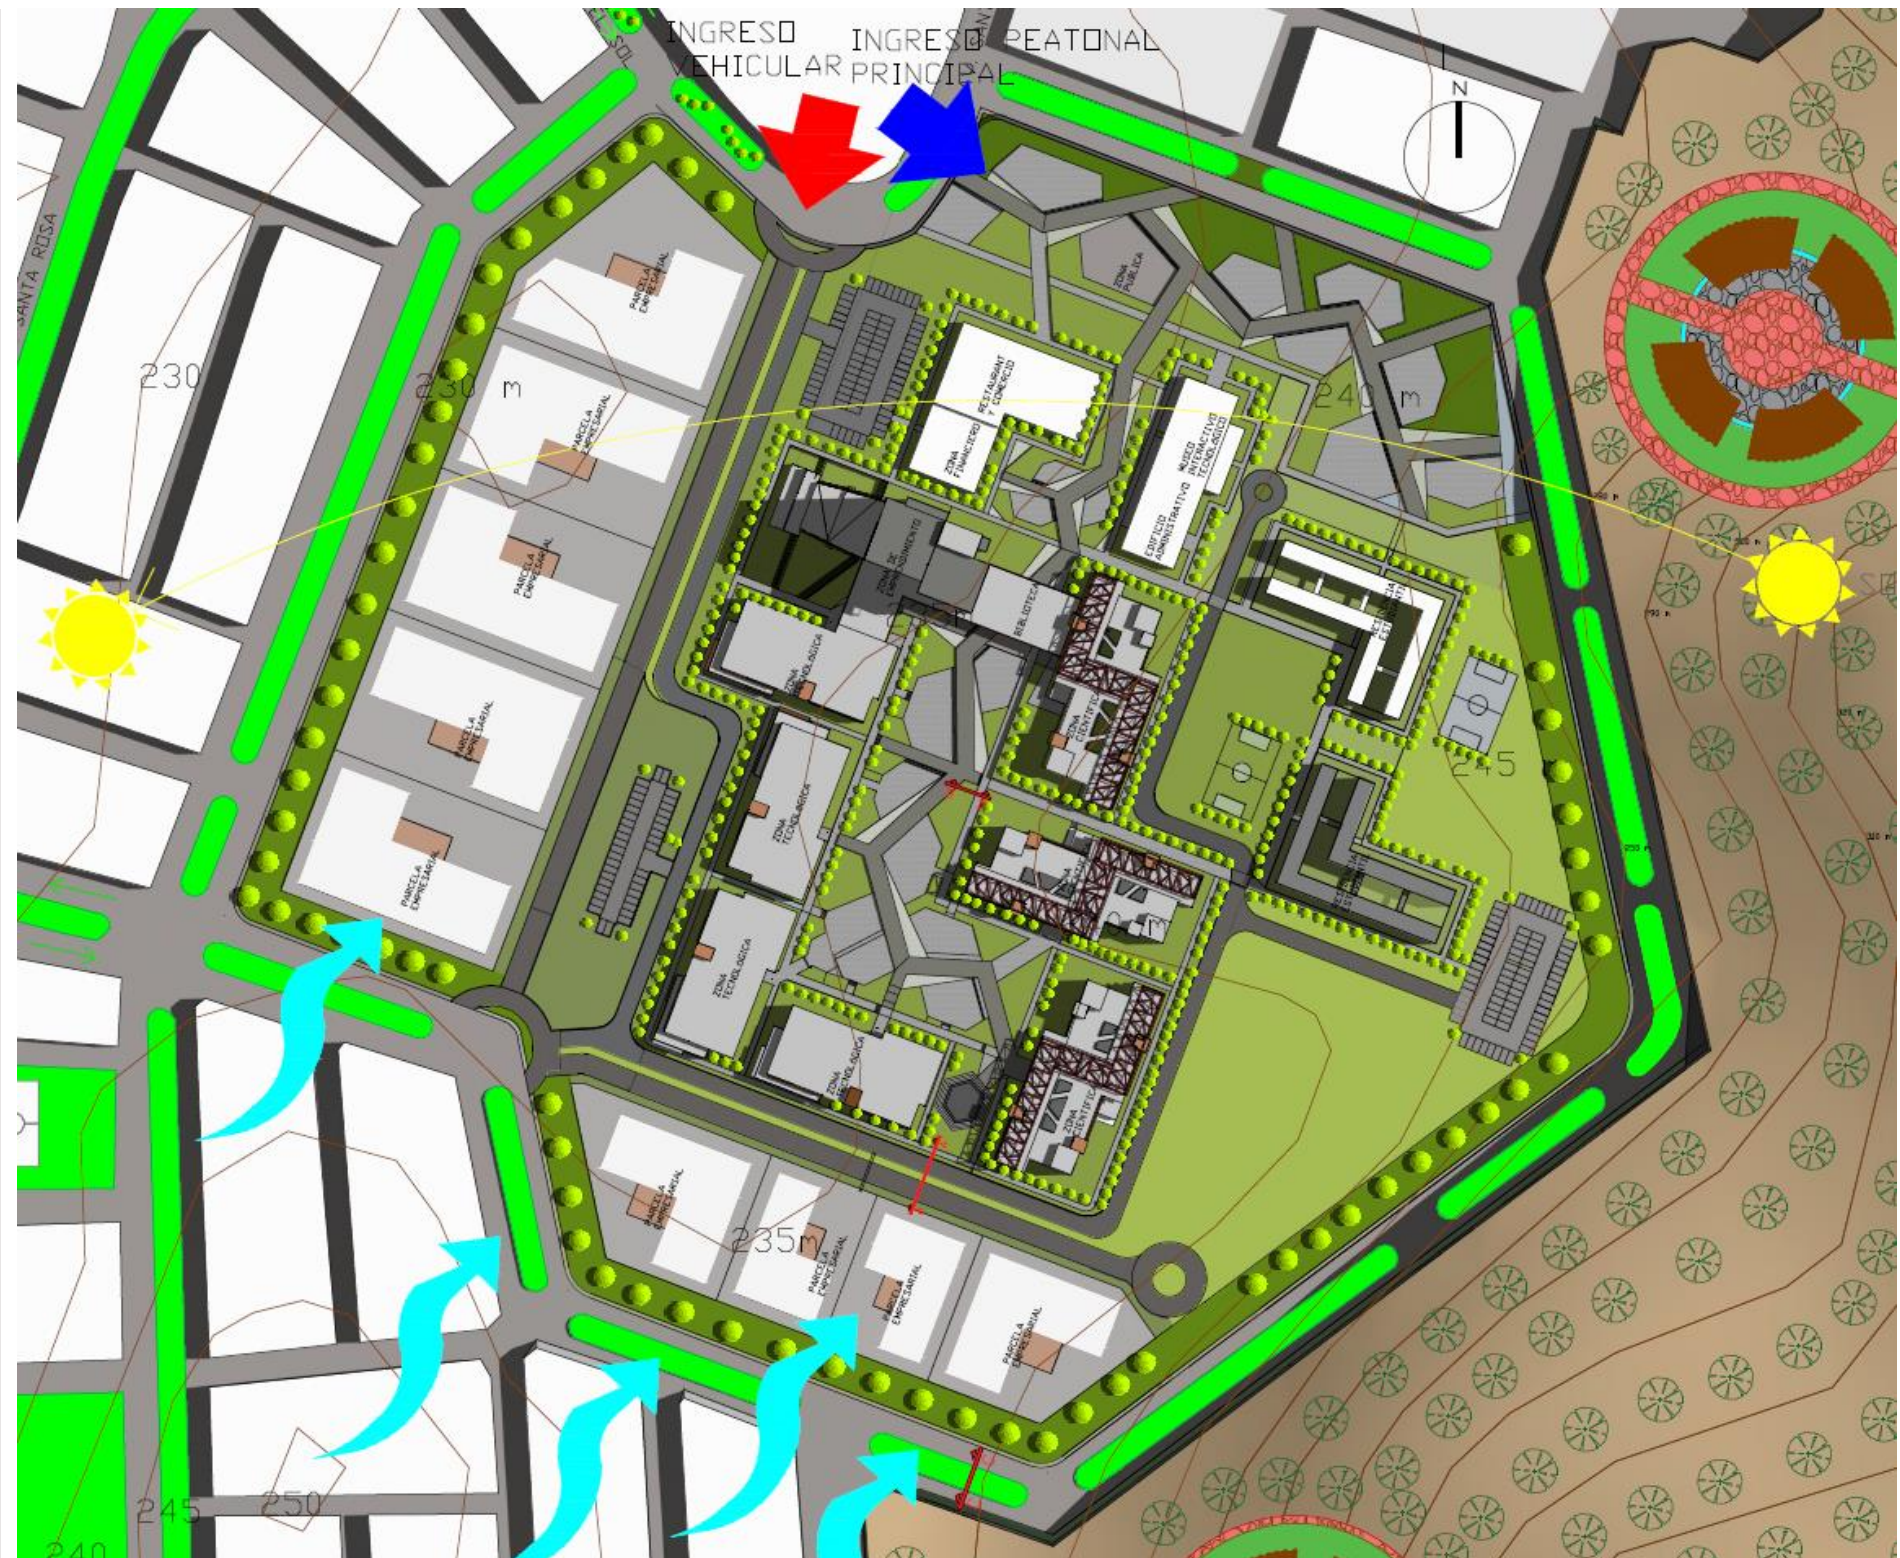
Propuesta de Máster Plan. Elaboración Propia.
